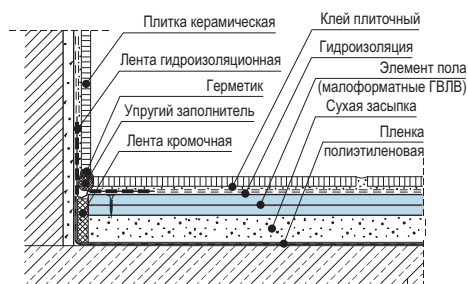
Примыкание к стене во влажном помещении (ванная комната)
